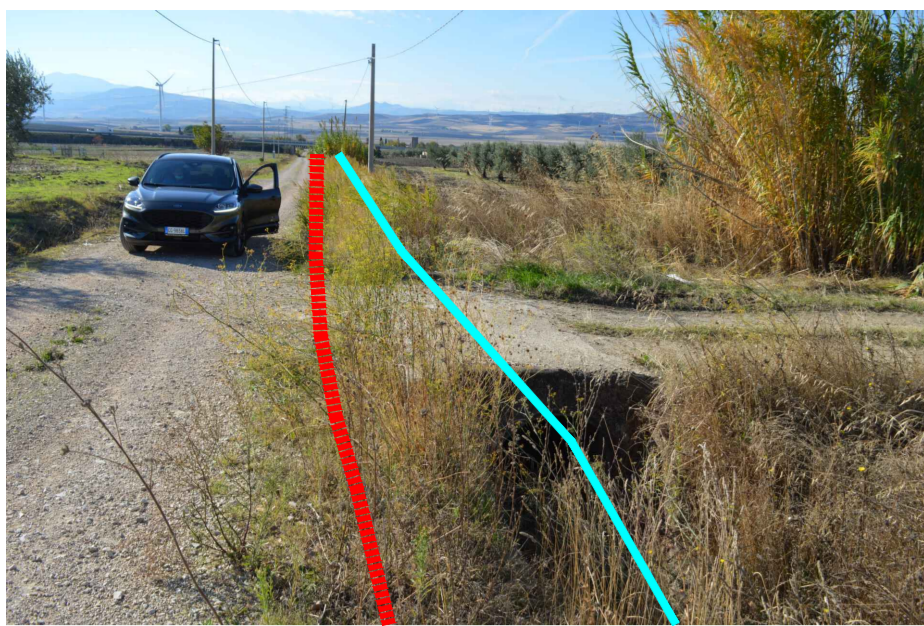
Attraversamento canale di raccolta acque meteoriche
